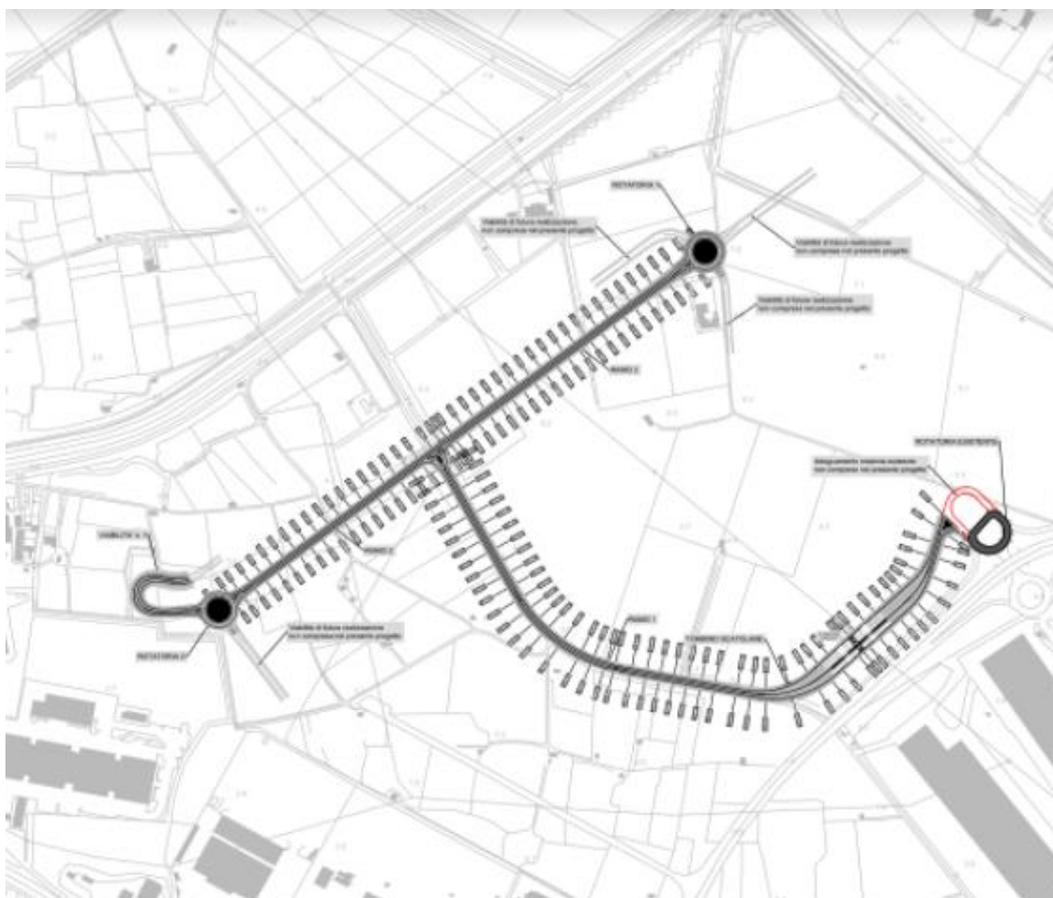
Tavola di accessibilità stradale. Fonte Elaborati di progetto
